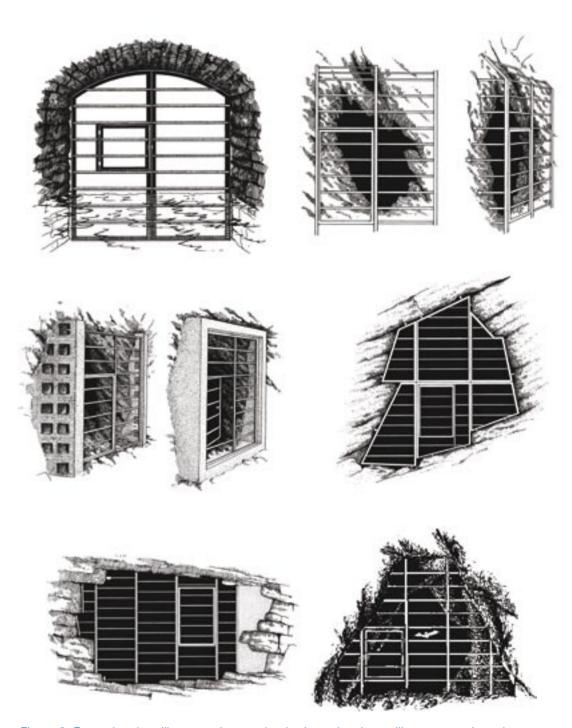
Exemples de grilles pour des entrées horizontales. Les grilles peuvent être plus grandes que l'entrée et scellées dans le rocher, ajustées à l'intérieur de l'entrée avec des chevilles et boulons, ou bien encastrées dans un cadre de béton pour régulariser et stabiliser l'entrée. Les grandes grilles larges peuvent être préparées en sections qui seront vissées ou soudées sur le site. Une porte d'entrée fermant à clef devrait toujours être ménagée.
